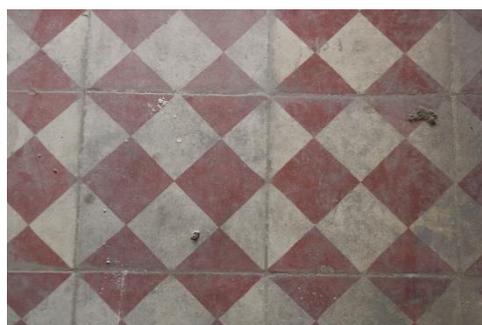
Zócalo de la fachada Cárcel de San Vicente (Fuente propia)
